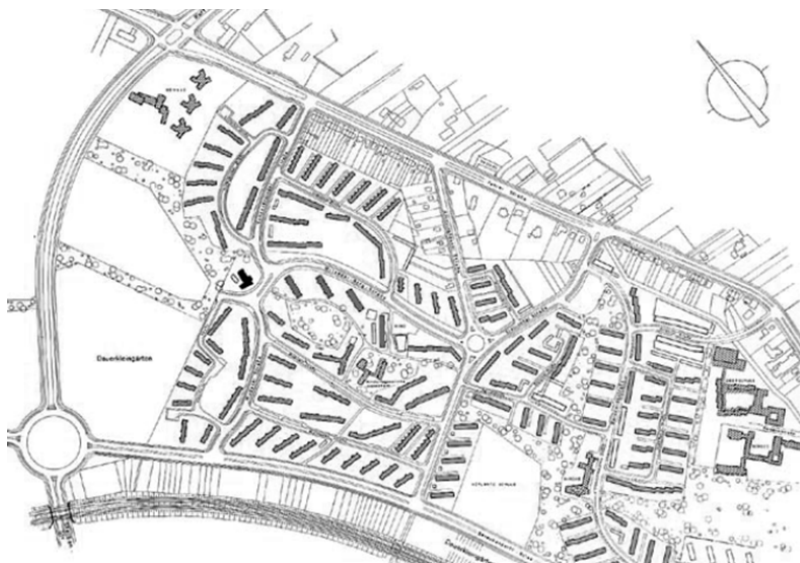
Lageplan der Gartenstadt Vahr (Syring, Architekturführer Bremen)
